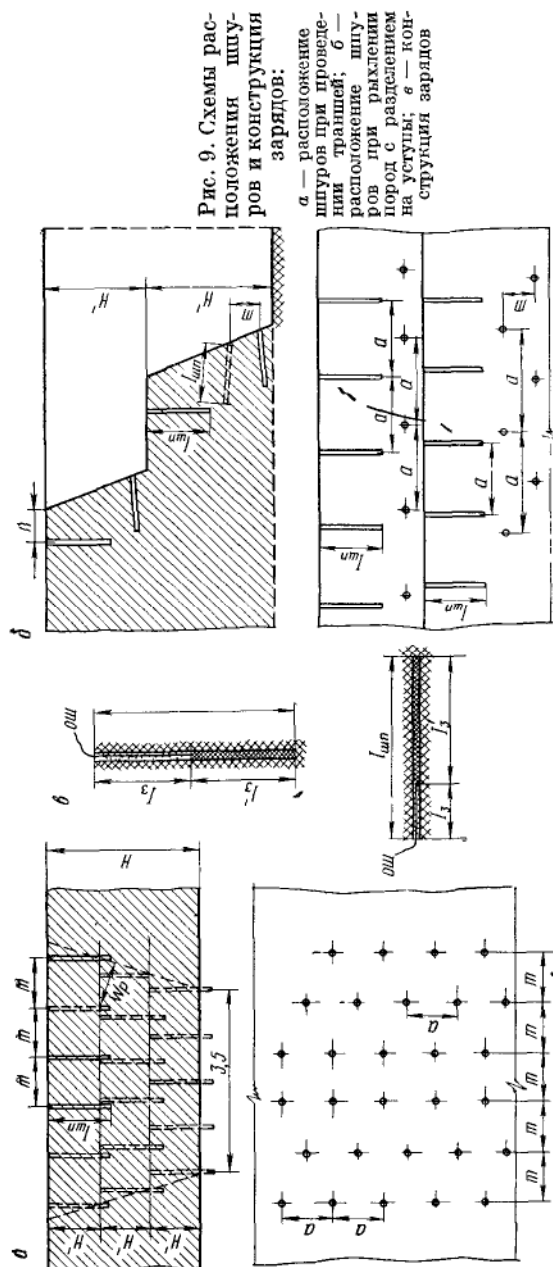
Схемы расположения шуров и конструкции зарядов:
